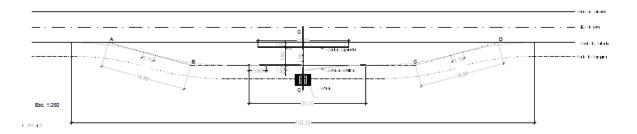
Perfil Darsenas de Pasajeros- fuente: Proyecto de Ingeniería
